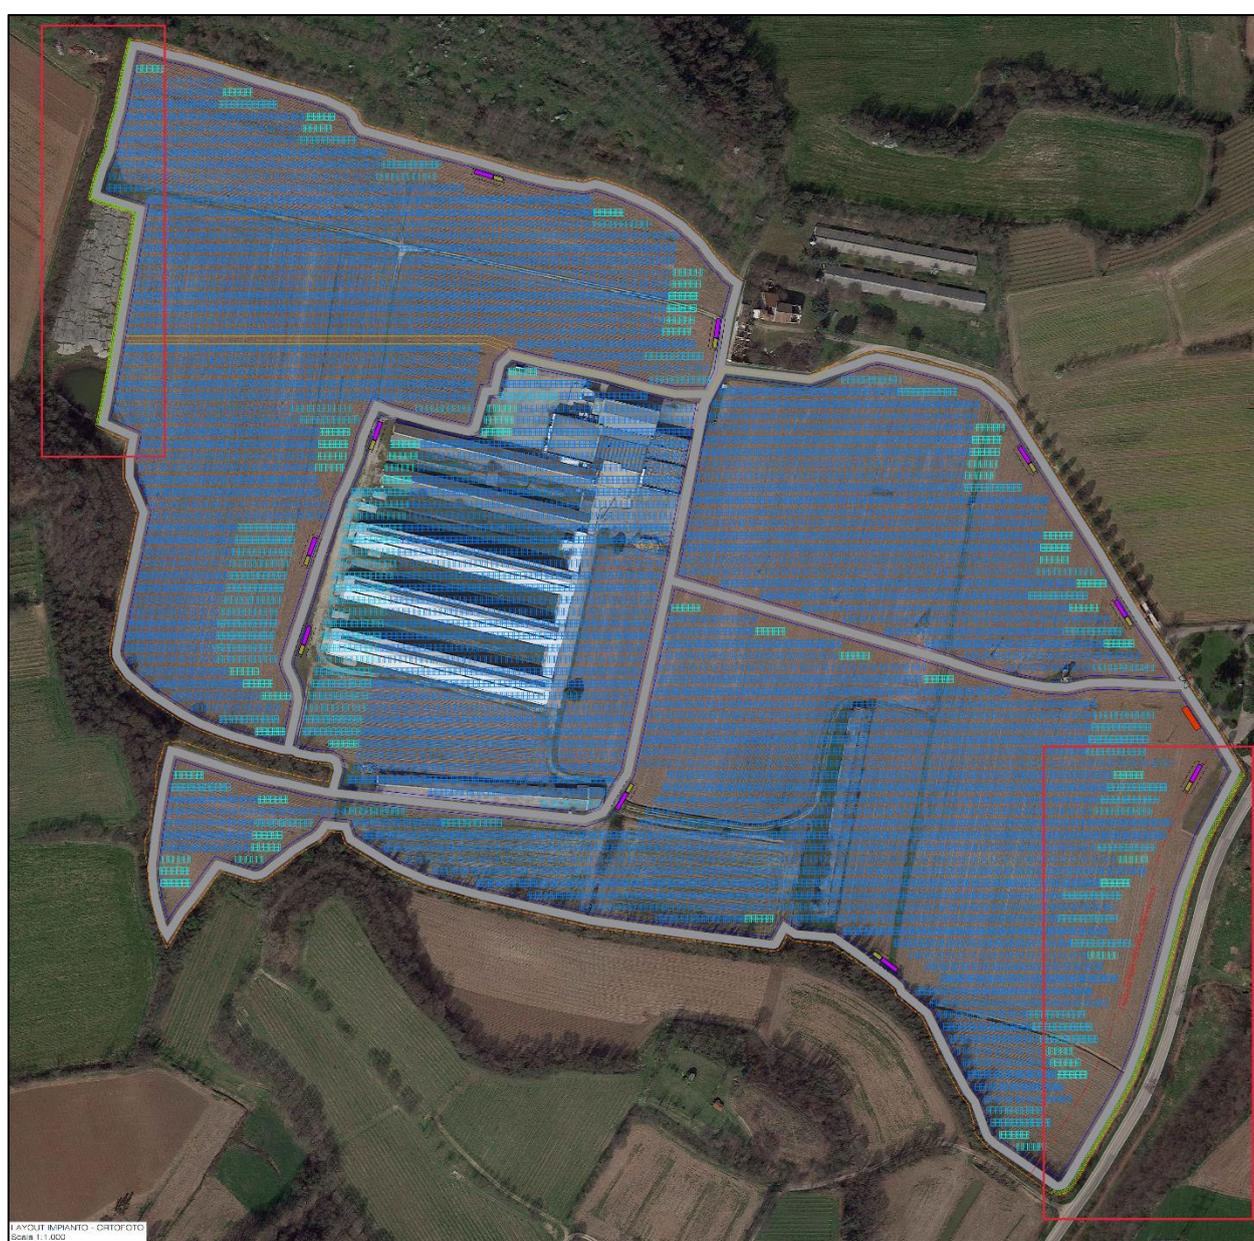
Layout dell'impianto su ortofoto e indicazione (nei riquadri in rosso) della posizione delle opere di mitigazione previste
